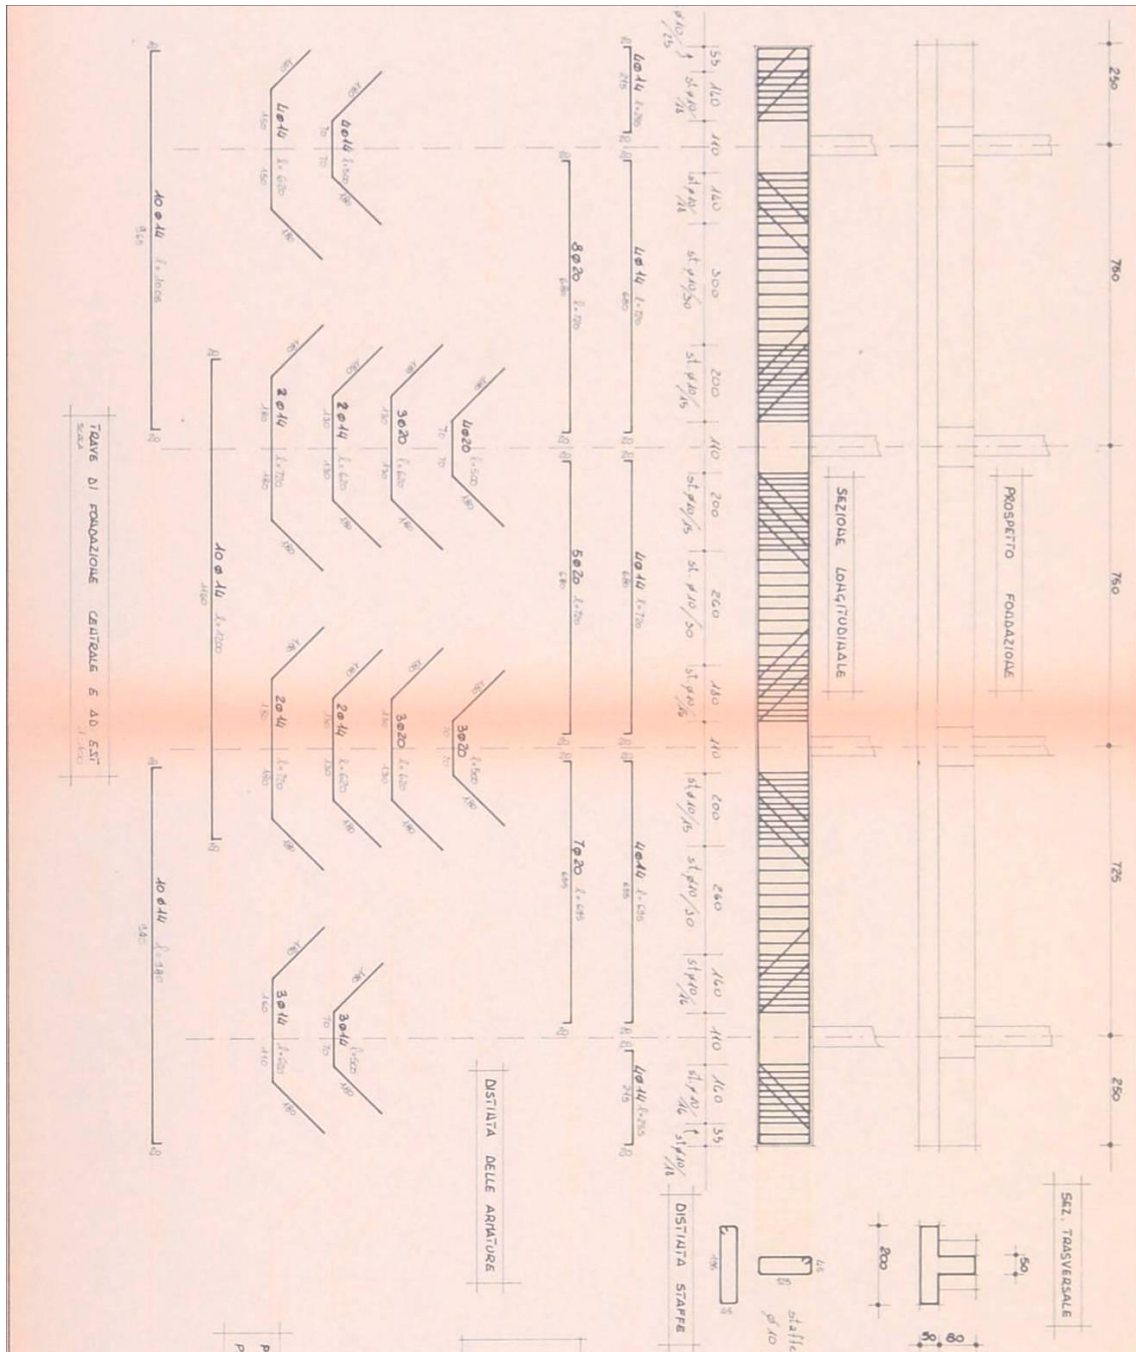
Particolare di A.1990.cap.us.T08 - Particolari delle travi di fondazione - Trave di fondazione centrale ed Est
